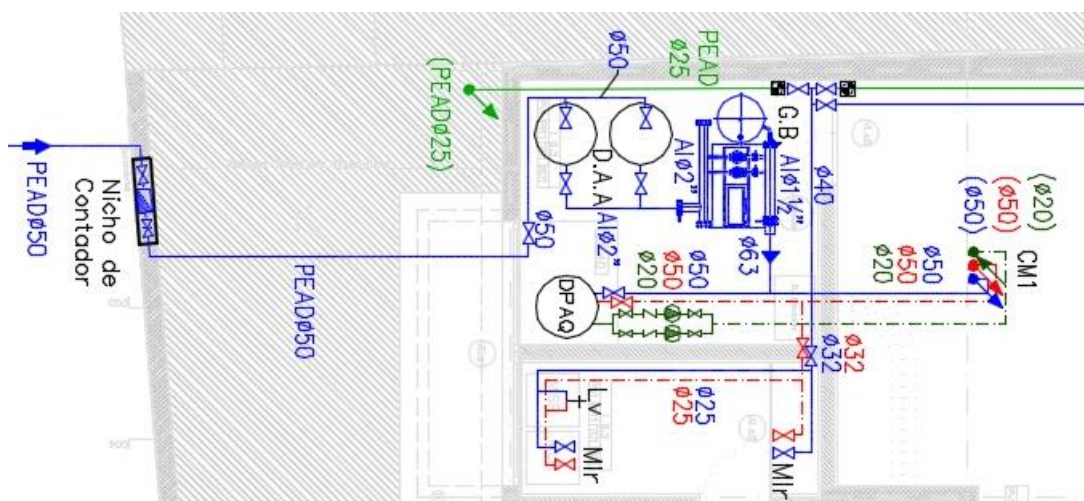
Pormenor do piso 0 da planta de abastecimento de água
